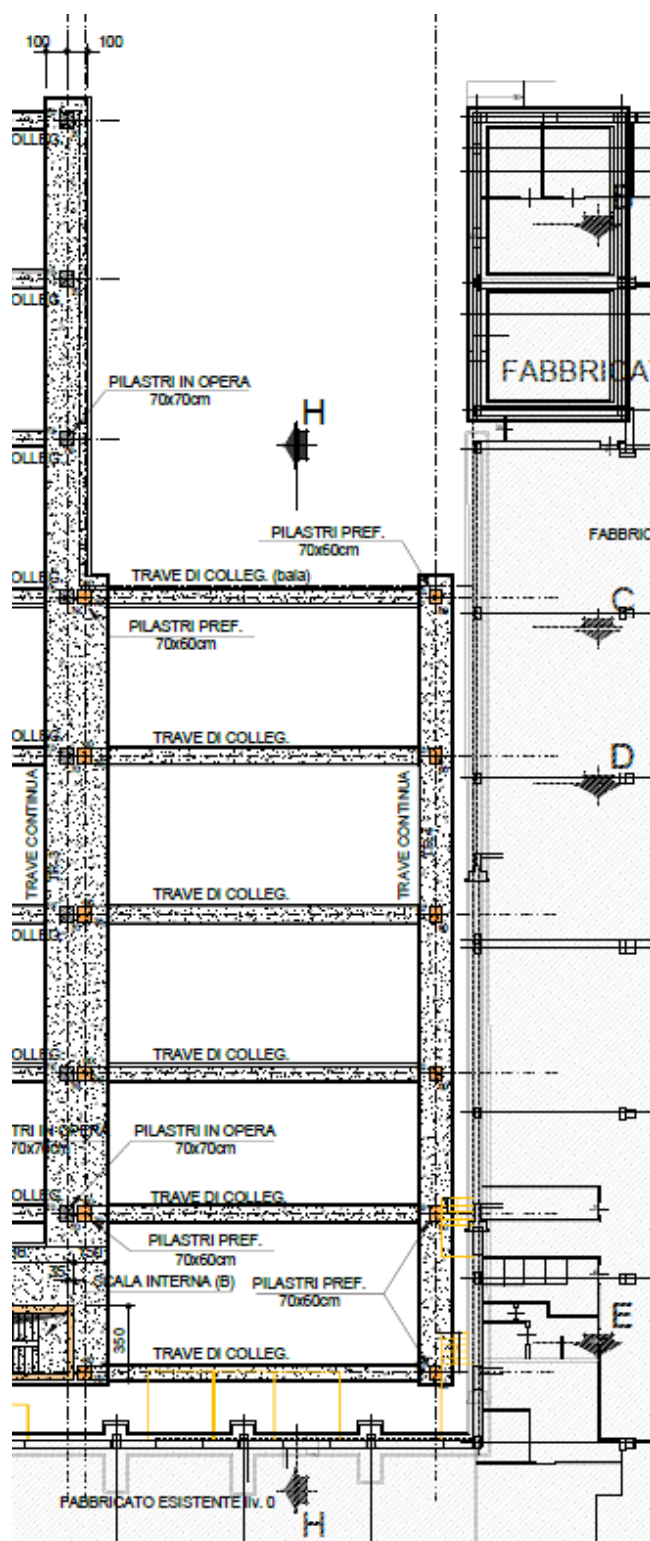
Planimetria fondazioni - Nuovo magazzino spedizioni
